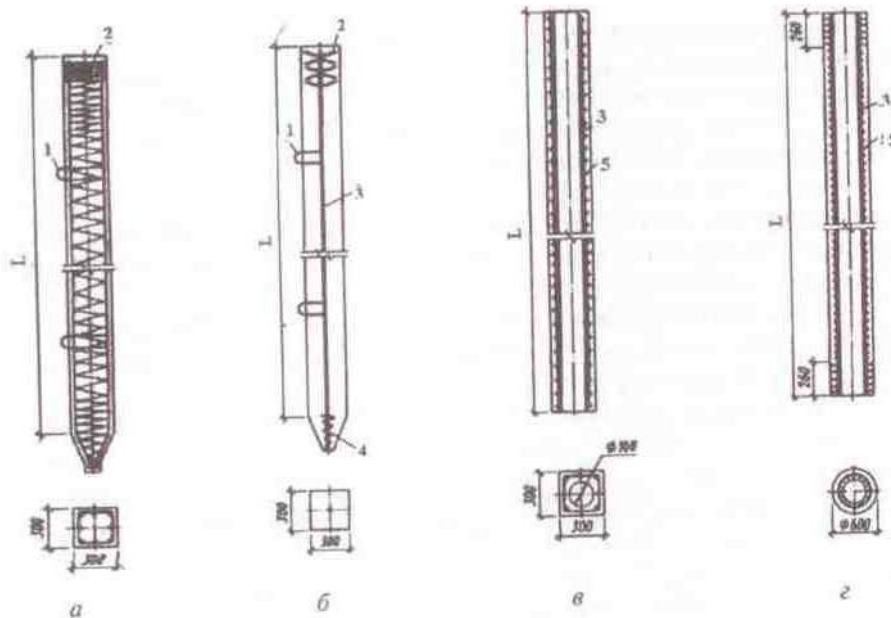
Конструкція залізобетонних палей: а – призматична з поперечним армуванням стовбура; б – теж, без поперечного армування; в – теж, з круглою порожниною; г – пола круга; 1 – стропильна петля; 2 – арматурні сітки голови; 3 – поздовжня арматура; 4 – спіраль вістря; 5 – поперечна спіральна арматура
